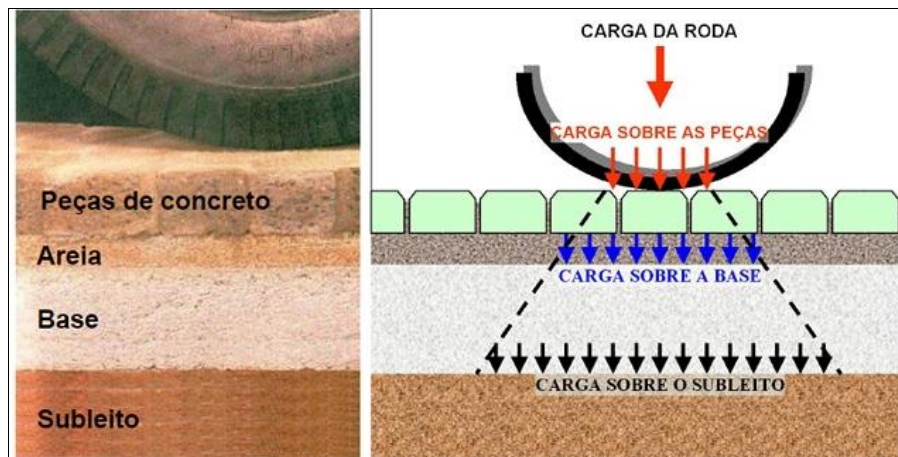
Distribuição das cargas verticais ao longo do perfil das vias pavimentadas com pisos intertravados
